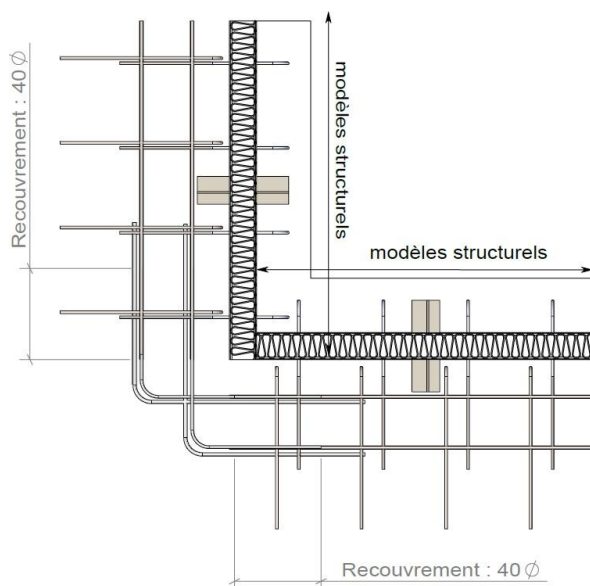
Ferrailage d'un angle sortant (vue en plan)
